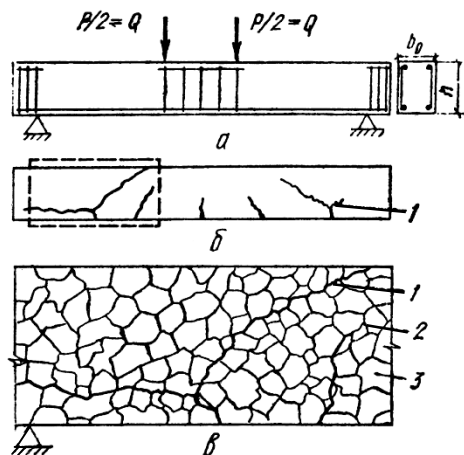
Схема нагружения (а) и характер трещинообразования (б, в) железобетонных балок
